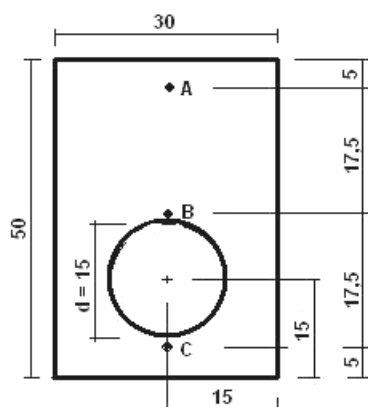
Dimensões da seção transversal do pilar armado P 30 x 50
